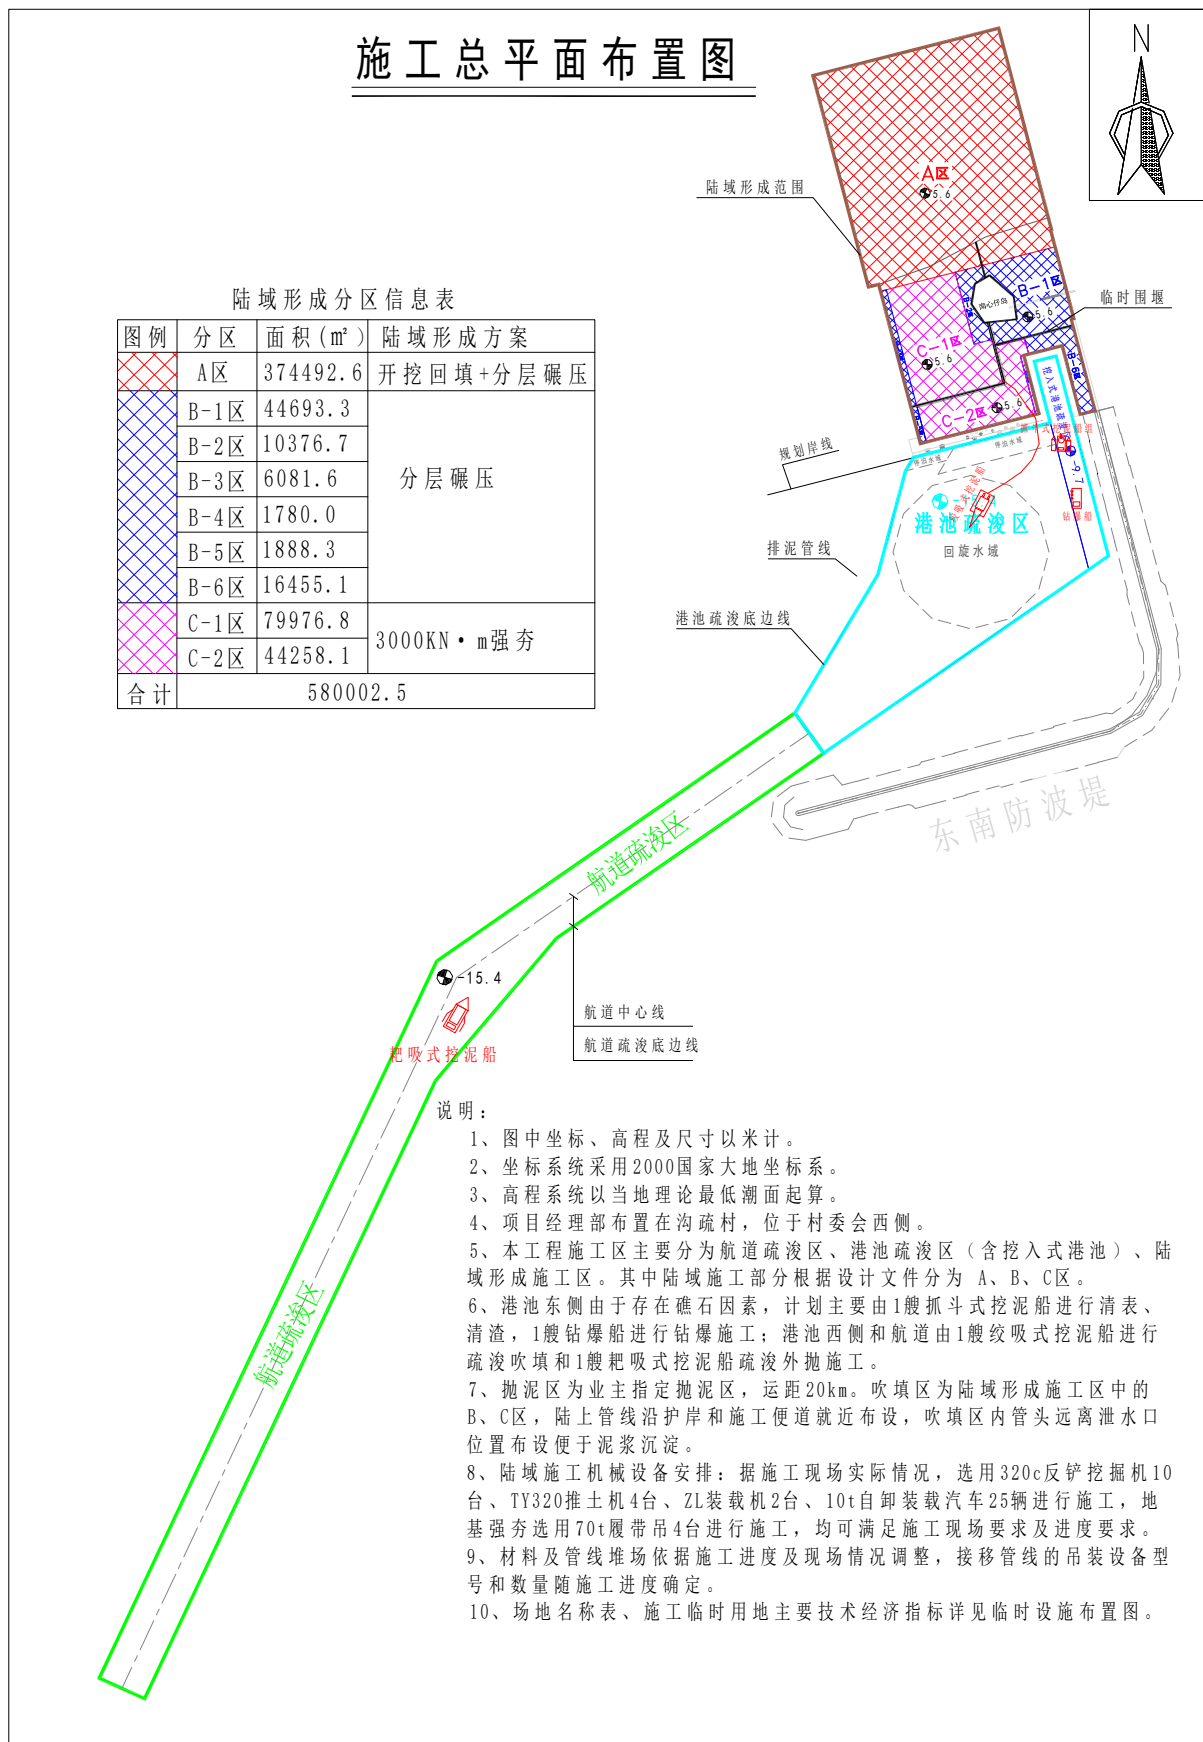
施工平面布置方案（本次论证仅涉及航道疏浚）
